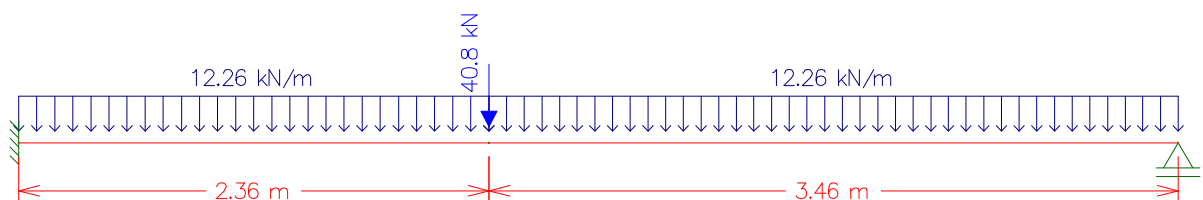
Esquema Estrutural com Carregamento Quase Permanente Viga 16 (Tipo).
